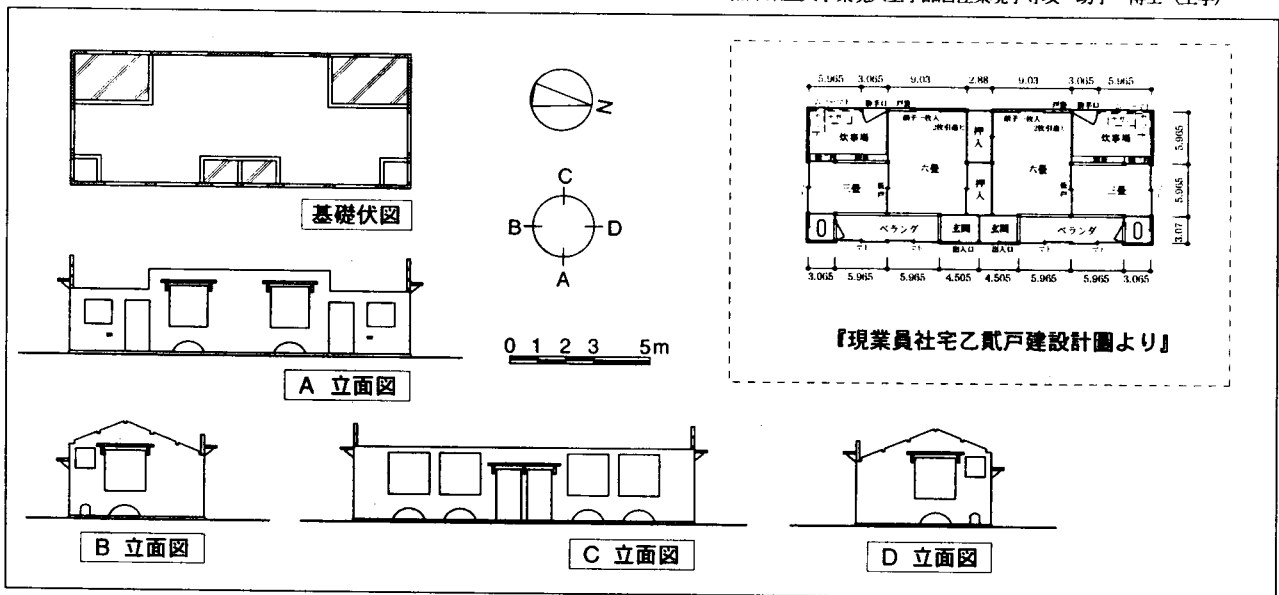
旧南洋興発二戸建社宅の現況平面図と立面図
